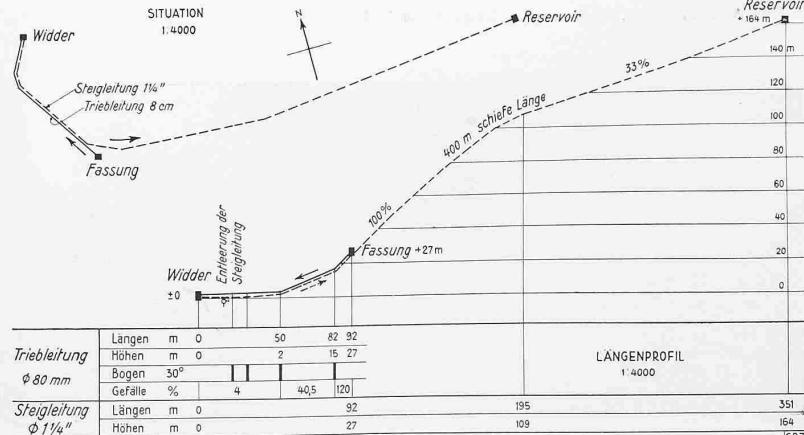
und 3. Lageplan und Längenprofil des hydraulischen Widders, 1:4000
